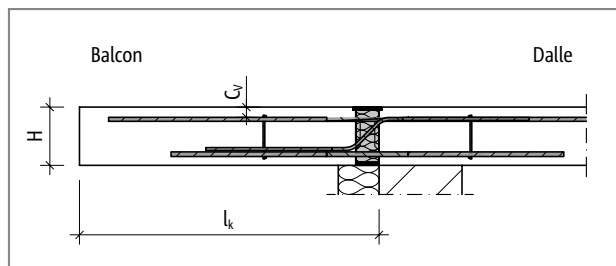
Schöck Isokorb® T Type K-M13 : Système statique
